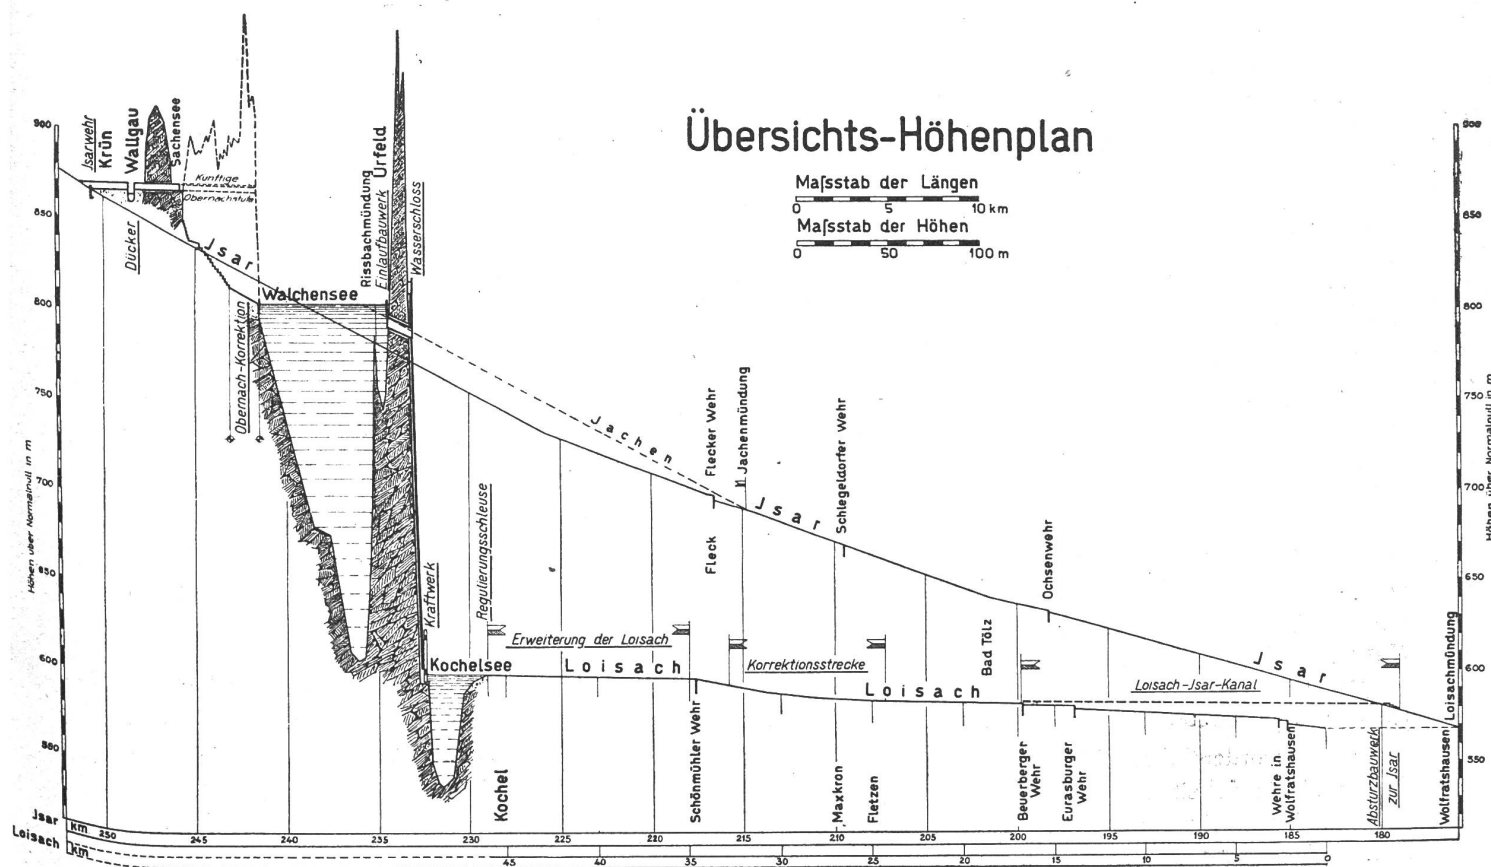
Walchenseewerk, Übersichtshöhenplan.
